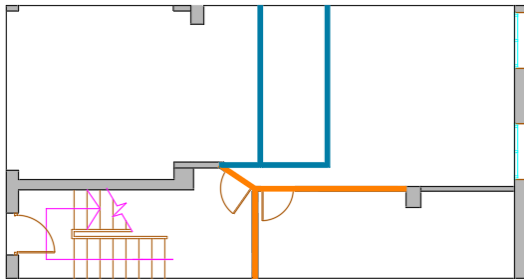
plano de demoliciones planta sótano. Fuente propia
